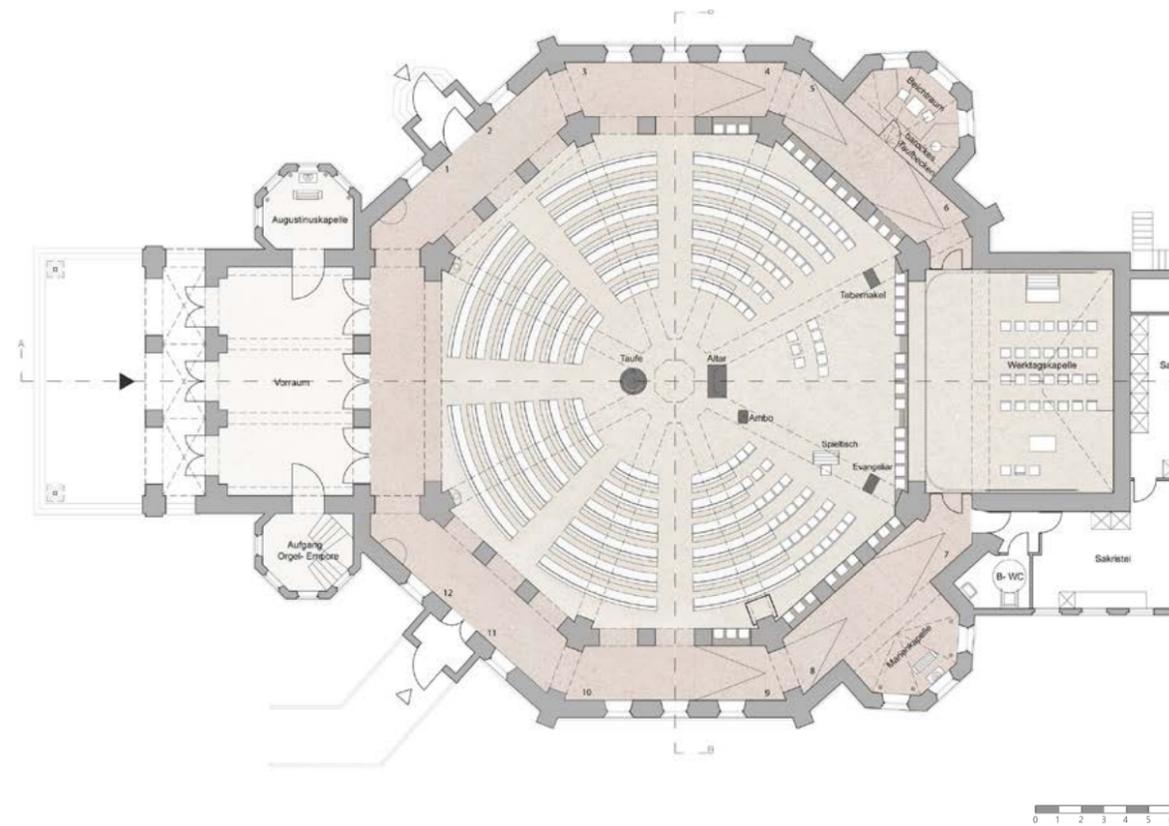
Grundriss St. Augustinus, Nordhorn
